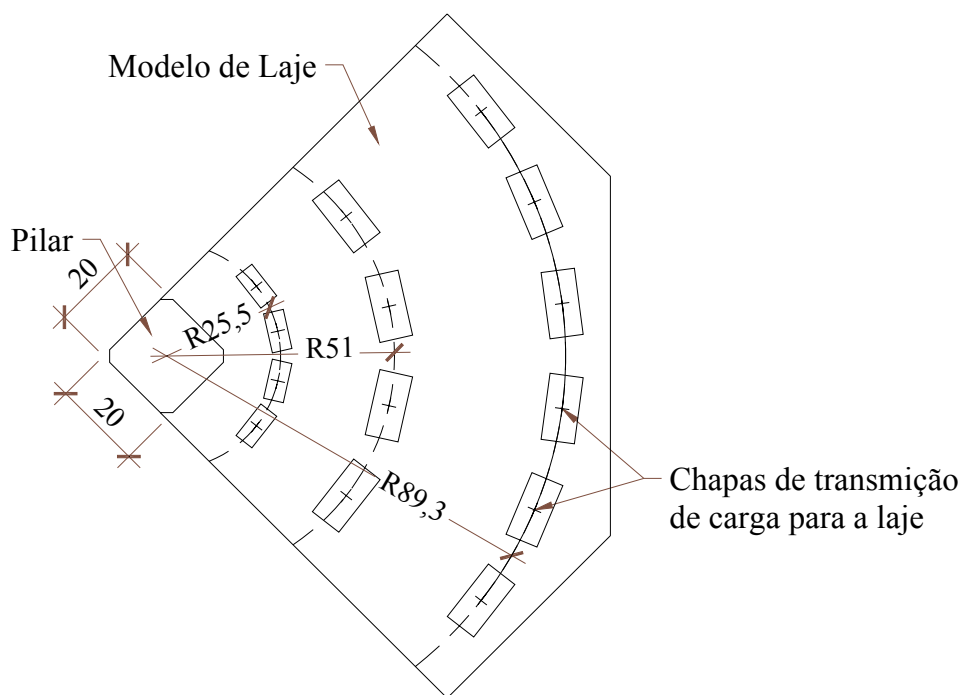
Planta do modelo de ensaio utilizado por Figueiredo (1983)
